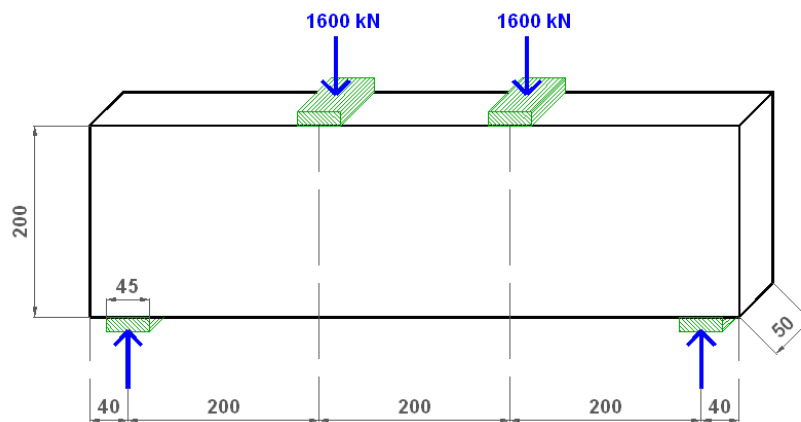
Viga-parede de estudo - dimensões: cm (adaptado de SOUZA, 2004)
